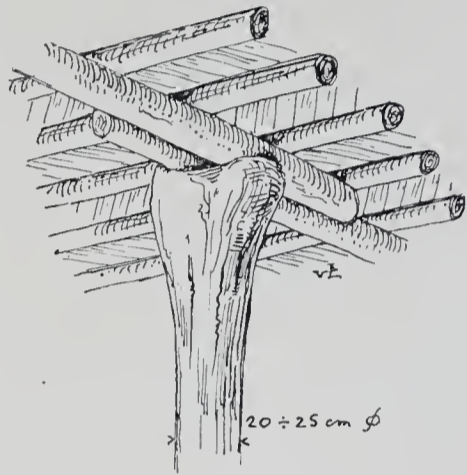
Deckenauflagerung auf einer Holzsäule.
